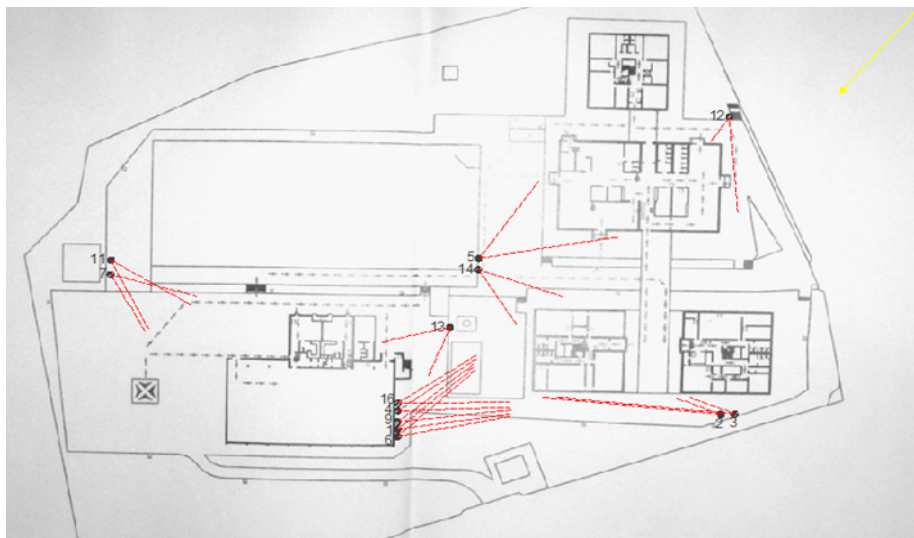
Planta da Escola com a localização dos alunos e o respetivo ponto de vista.
